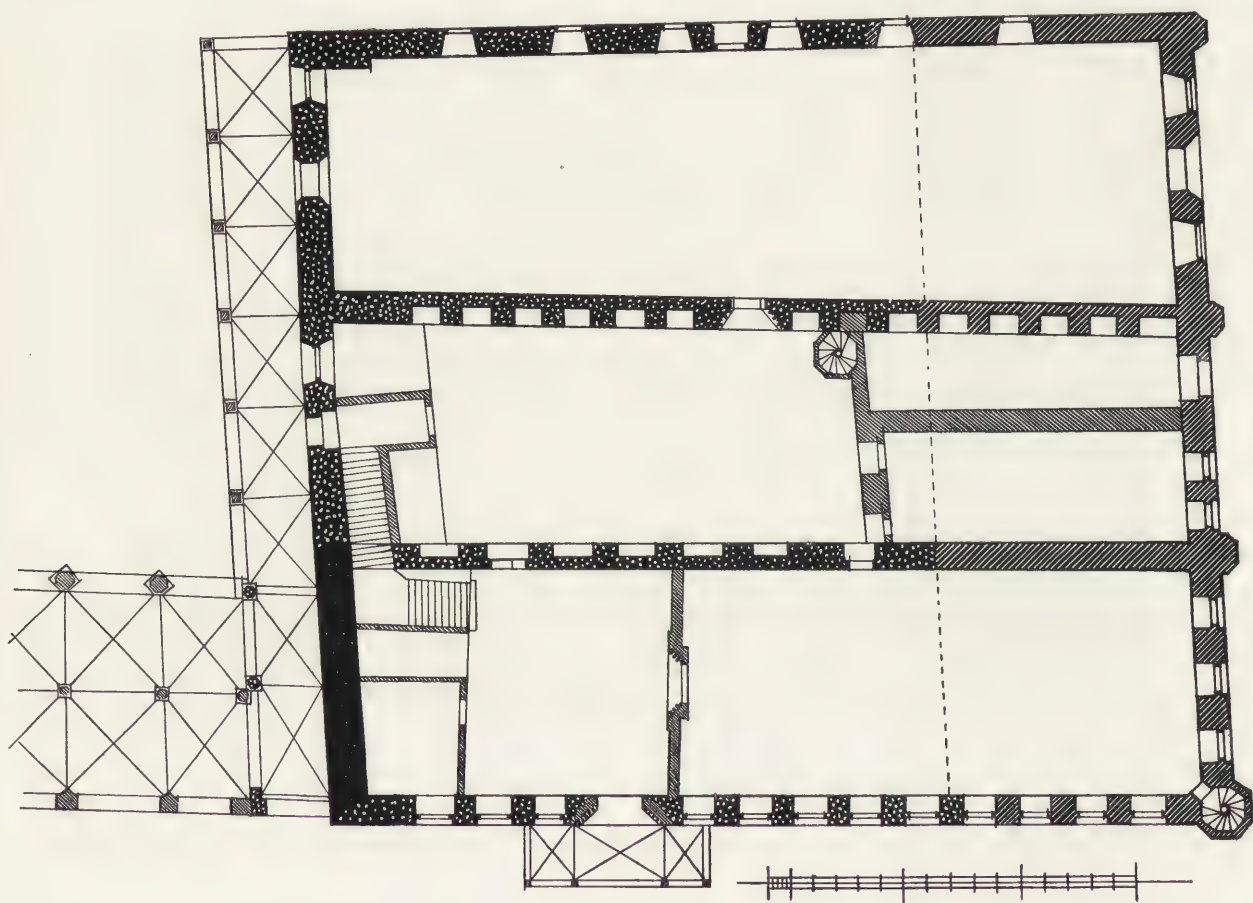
Rathaus zu Lübeck. Grundriß des Erdgeschosses vom Kernbau.
